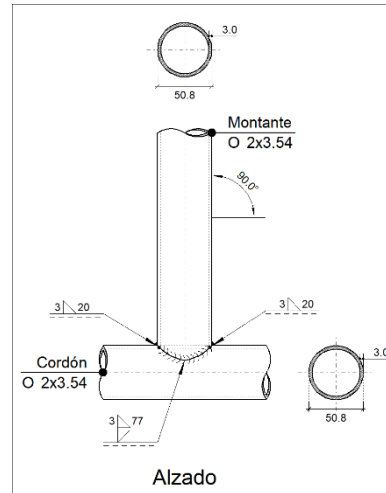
Detalle Unión 1 y 2 Fuente: Cype Ingenieros
